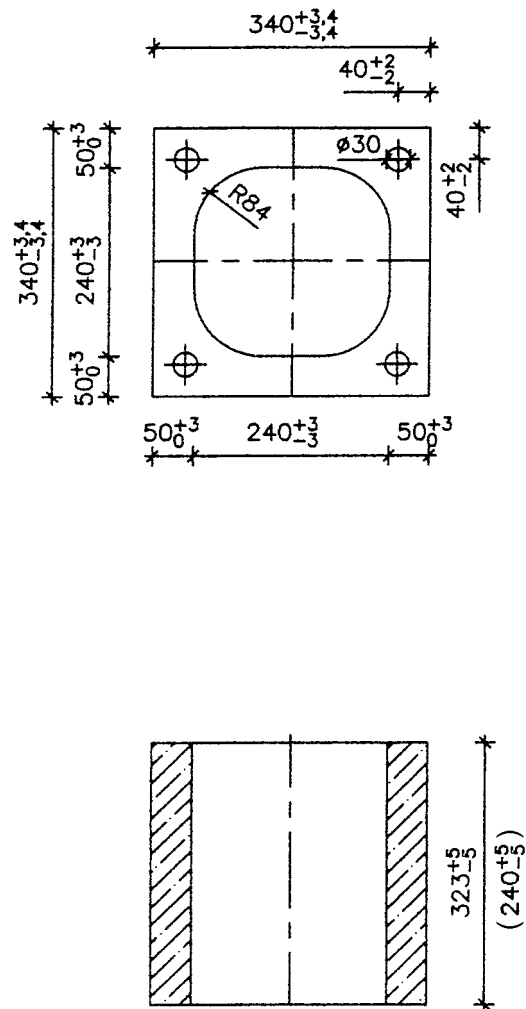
Profile szamotowe typu PLEWA-UNI-fu o przekroju kwadratowym — część II
